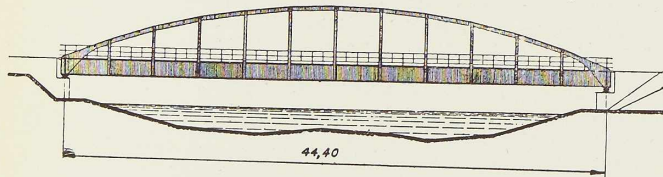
Pont-route soudé, en construction sur la Mürtz à Wartberg (Autriche).
